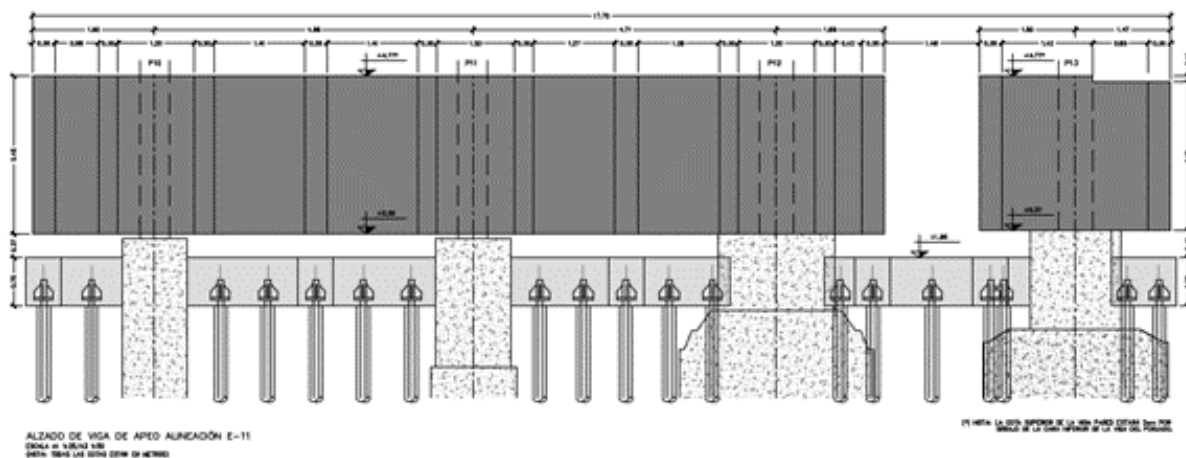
Construcción de encepados y viga pared de transferencia. Procedente del proyecto de ejecución.
